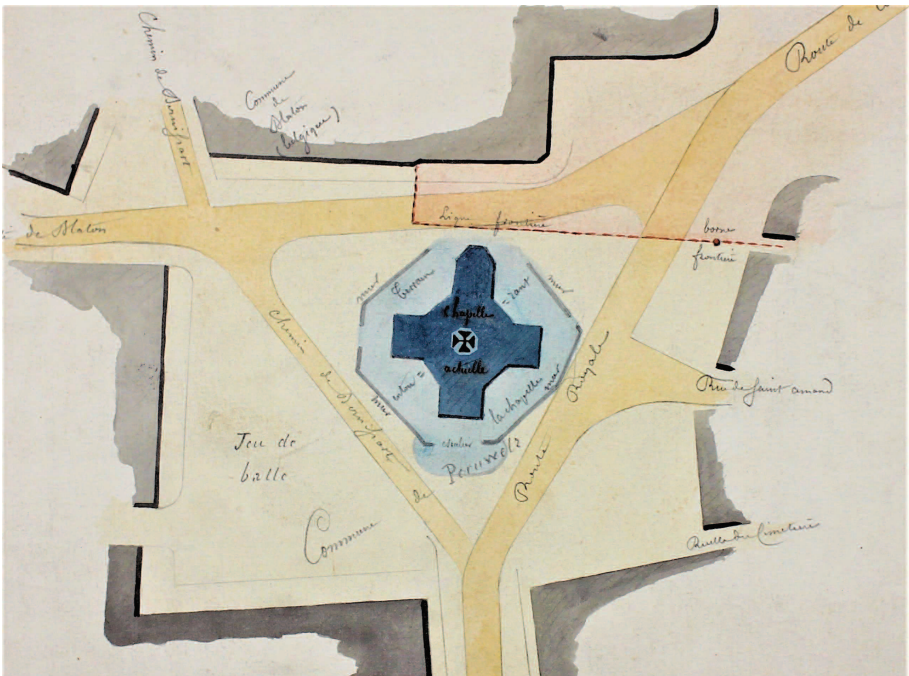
Plan du site, anonyme, vers 1870-1880. ACRMSF. © Auteur.
